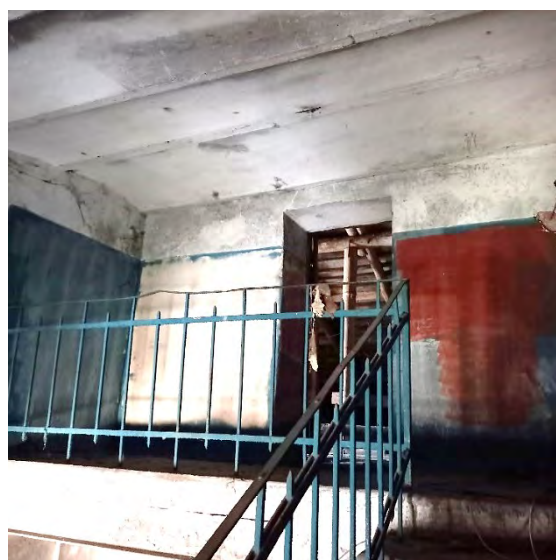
Вид с лестничного марша ЛК на вход на чердак
